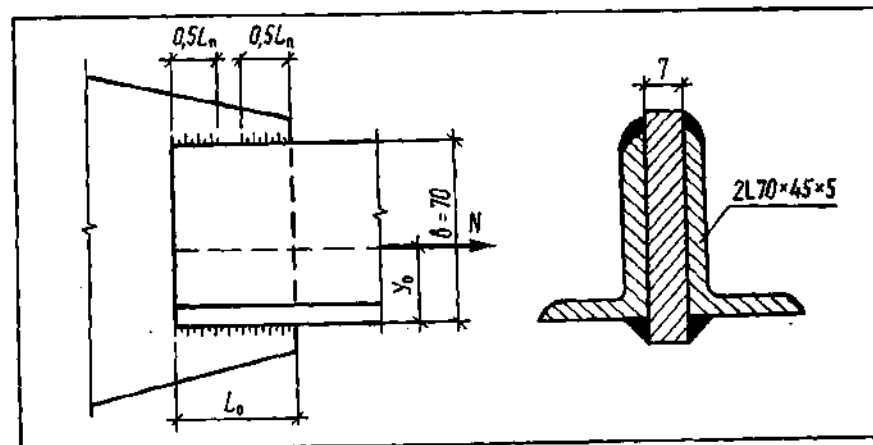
Расчетная схема элемента фермы (пример 3.3)
